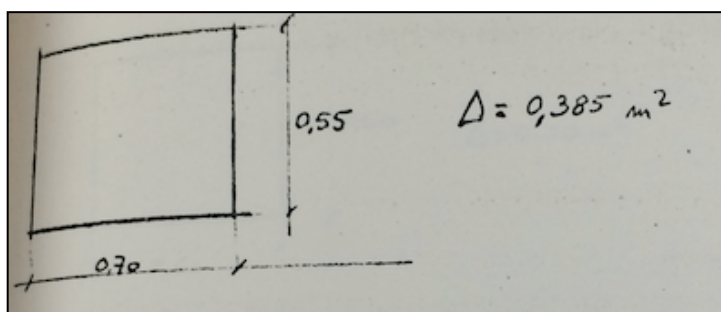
Esquema secció pilars de les plantes inferiors
